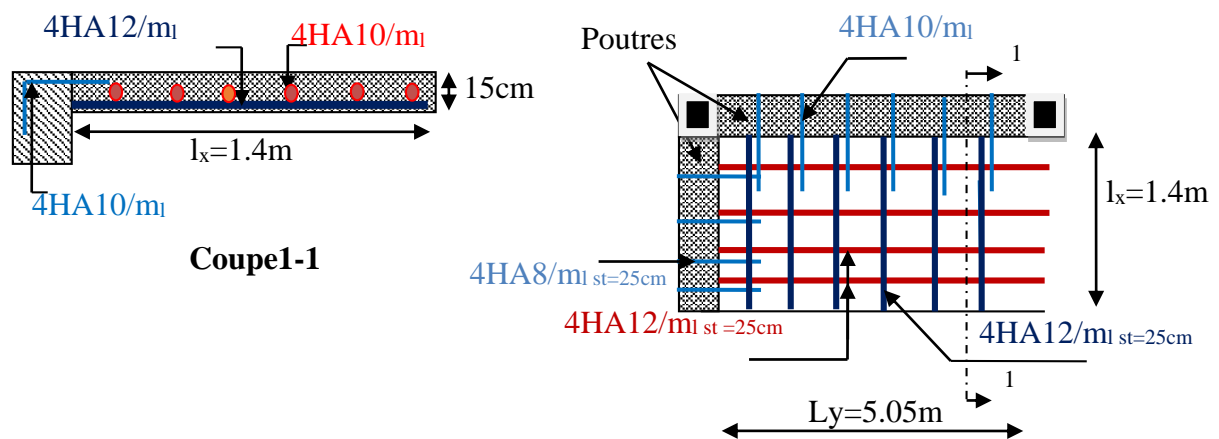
Schéma de ferrailage de dalle balcon.
